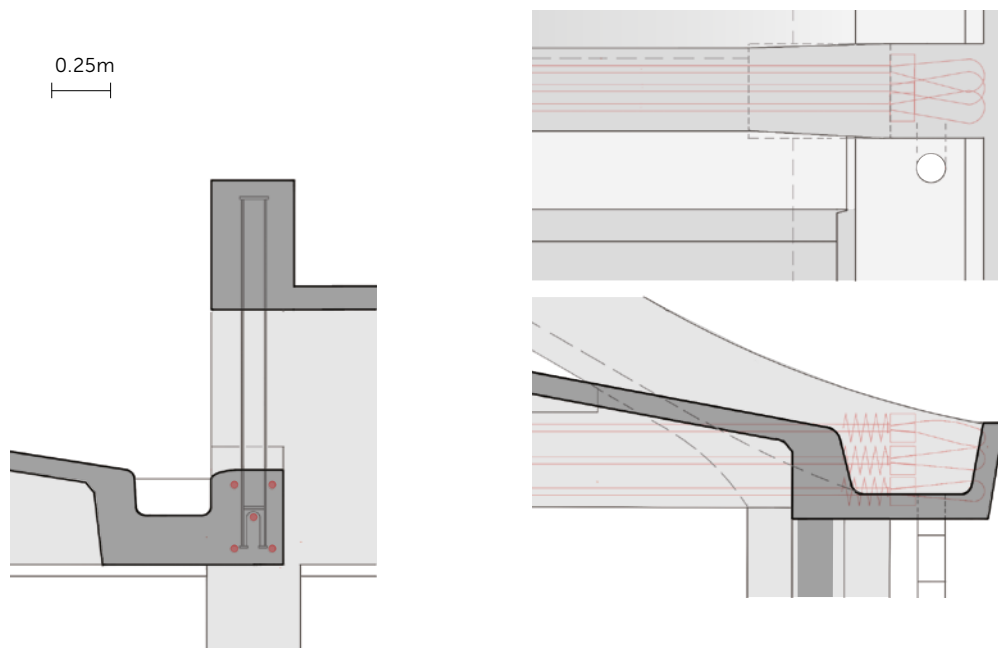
/17 Détails des ancrages des dalles à l'emplacement des appuis, source: Thomas Ekwall, 2021
